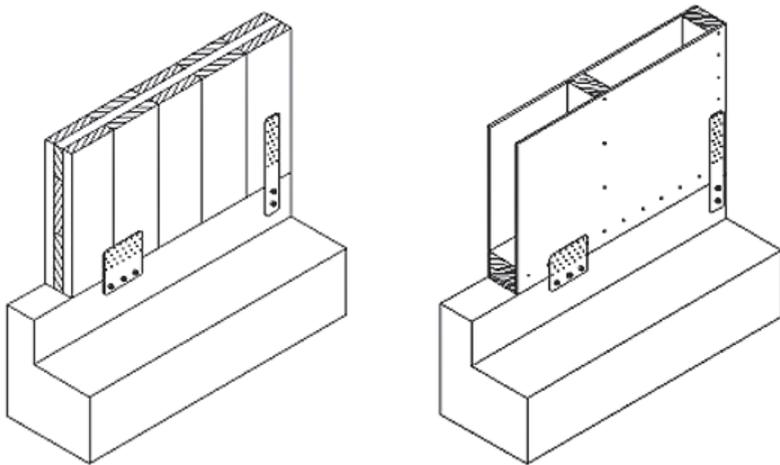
Appoggio della parete su zoccolo di fondazione: collegamento a trazione e a taglio mediante piastre forate, rispettivamente per pannelli XLAM e intelaiati
